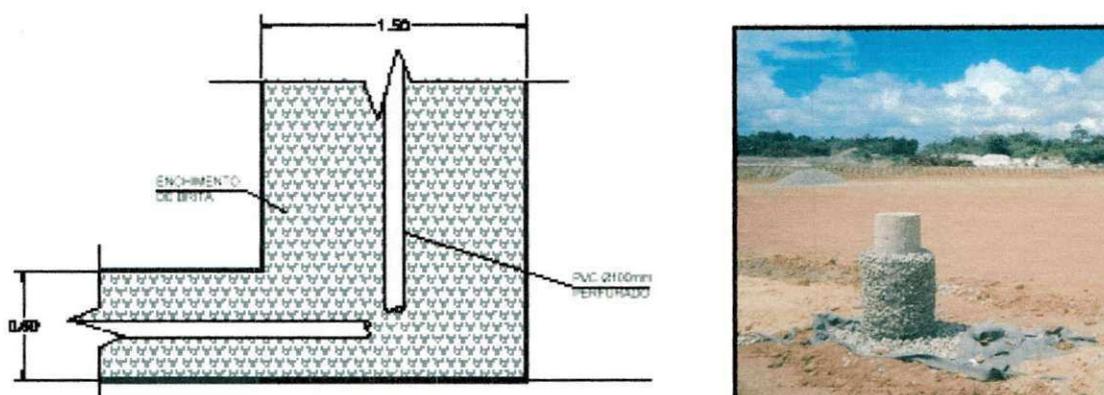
Detalhe em corte e em foto do dreno para gases projetado
